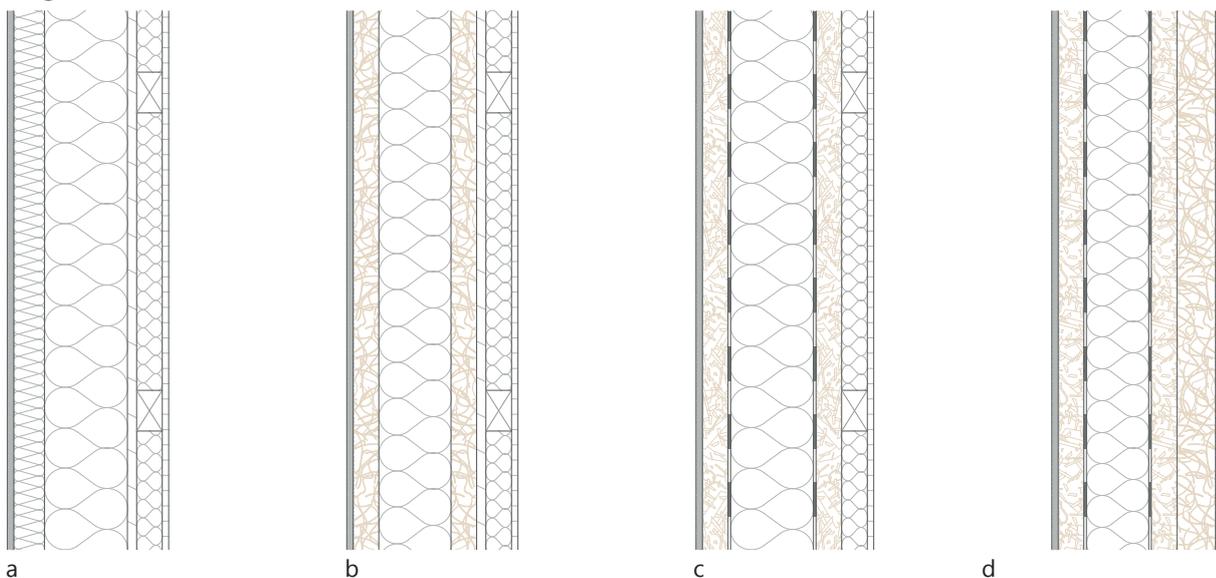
Holzständerwand in Rahmenbauweise; a Konventionell mit Putzfassade und Installationsebene; b Einfache Erweiterung mit HLB als Dämmung; c Alternative Beplankung mit HLB; d Zusätzliche HLB-Installationsebene
